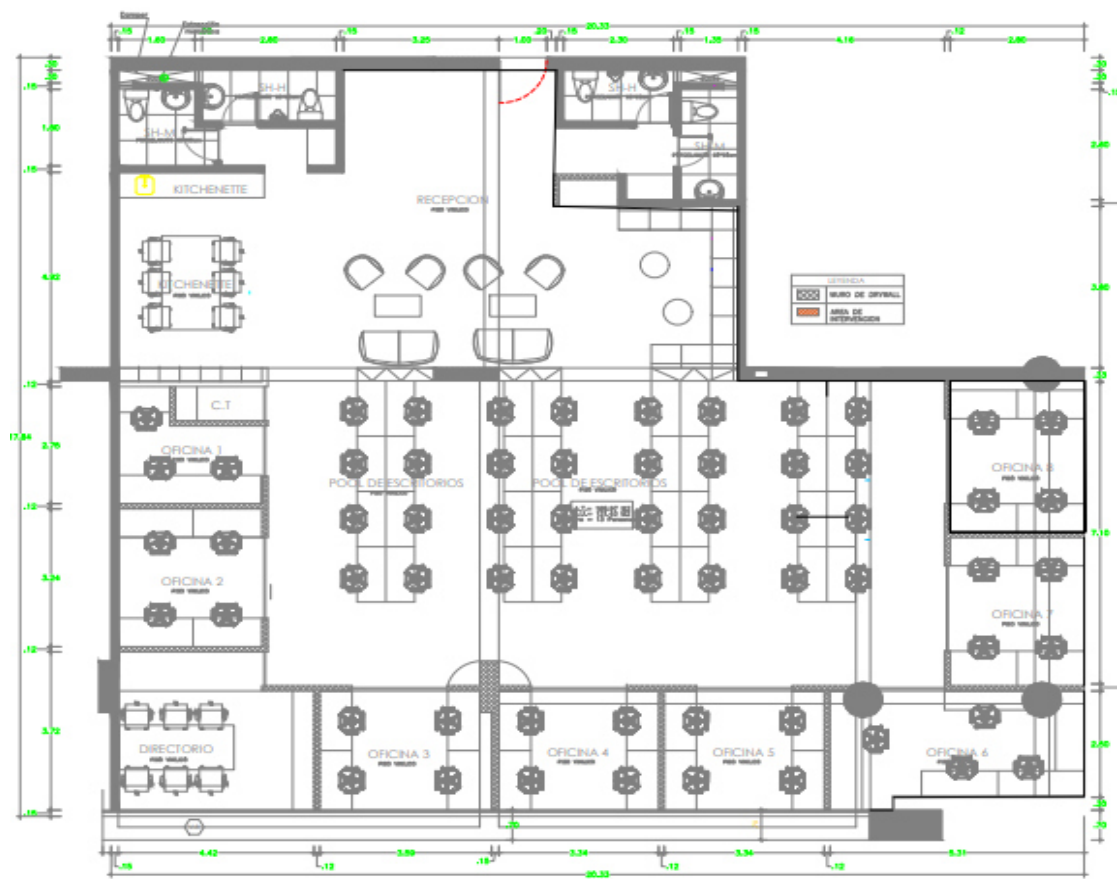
Plano de Arquitectura Primer piso. AZURRA CONSTRUCTORES SAC.
